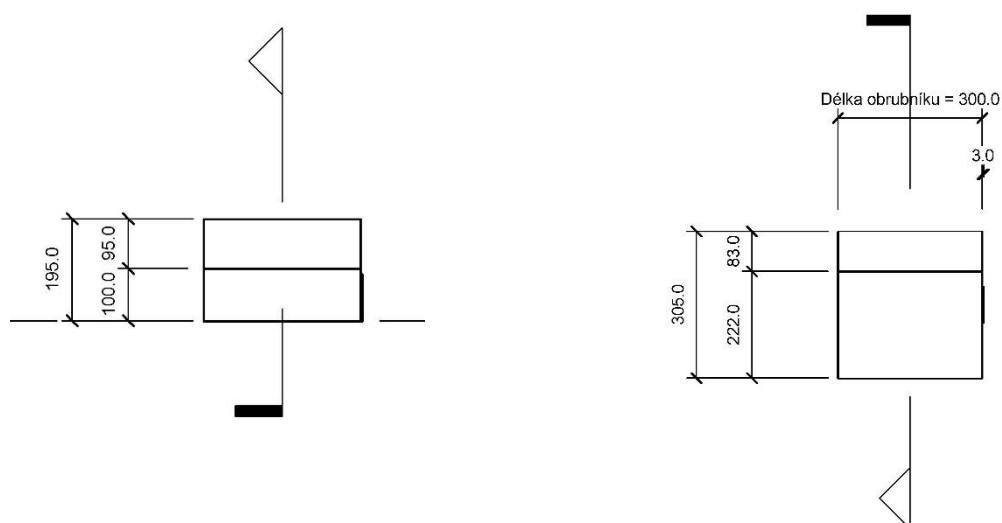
Obrubník ostrůvkový - uložení do betonového lože
